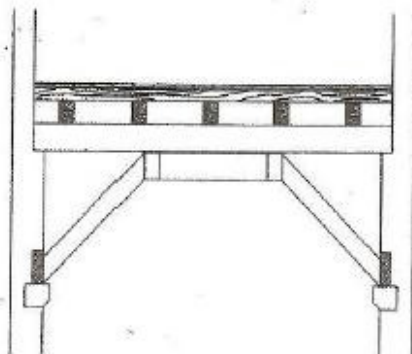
Escoras de apoio a vigas de pavimento (Carrió;1998).
